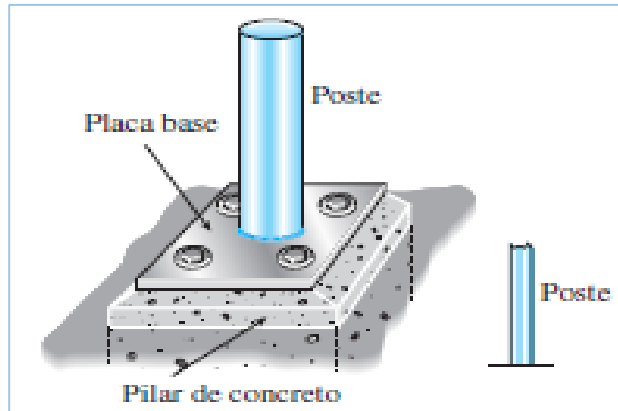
47. Poste anclado a un pilar de concreto: construcción real y representación como un apoyo fijo.
